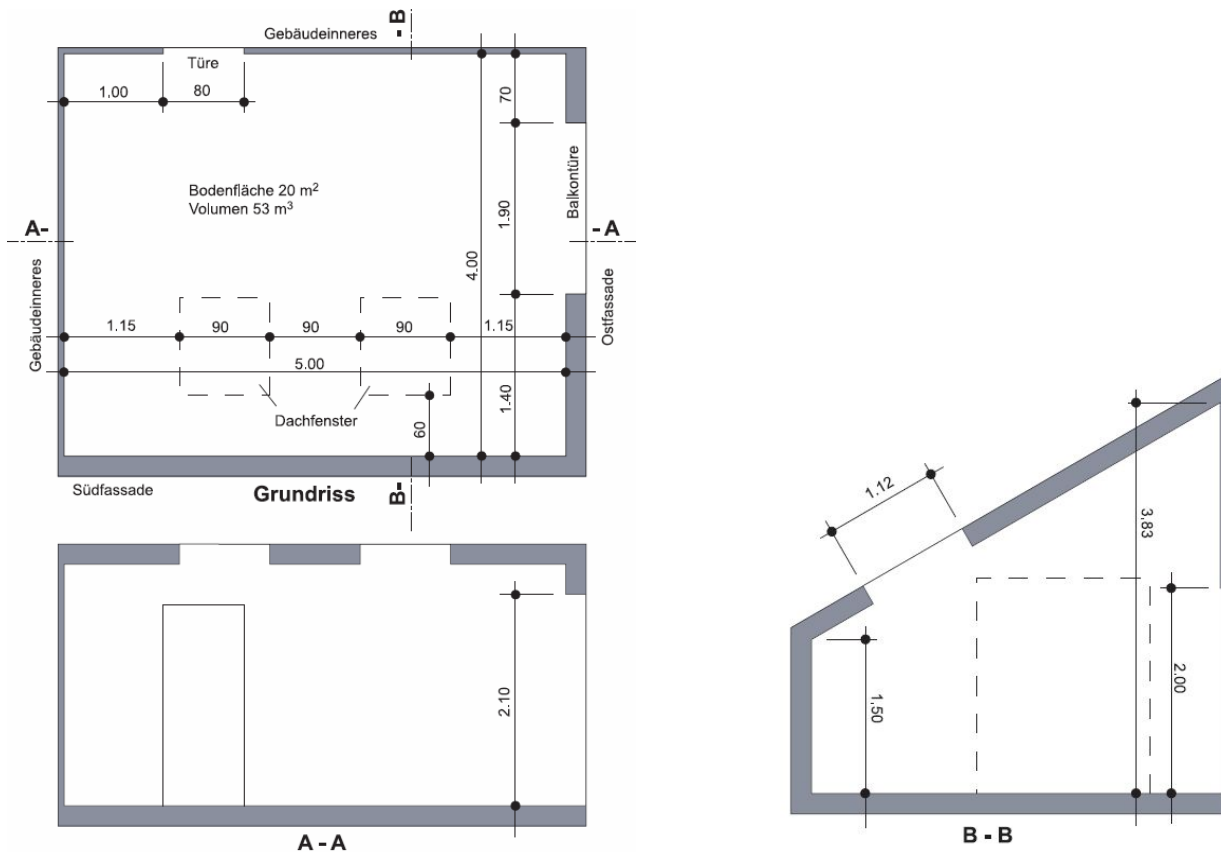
Grundriss und Schnitte des untersuchter Dachraumes mit Steildach und 2 Fensterflächenvarianten
